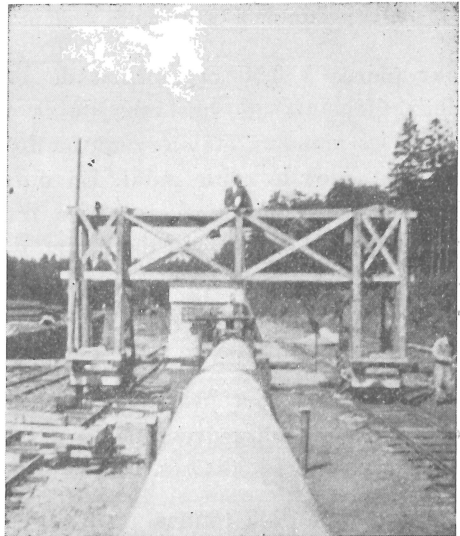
Aspect de la poutre tubulaire de 24,00 m fléchié.
